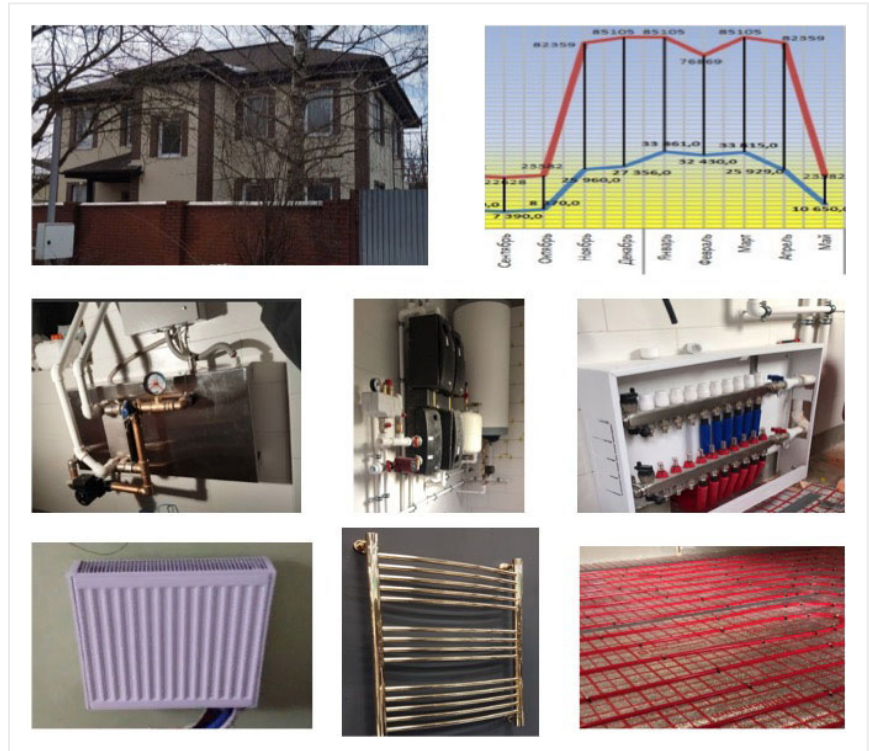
Автономный тепловой пункт АТП «ТермаРОН» для отопления и ГВС индивидуального жилого дома площадью 240 кв. м (МО, г. Химки)
